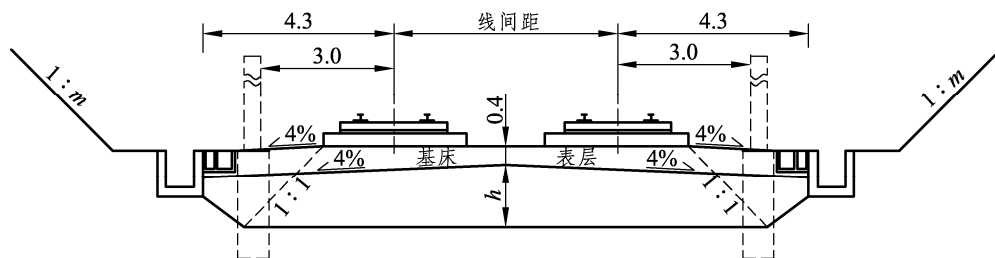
无砟轨道双线路堑标准横断面图（单位：m）
